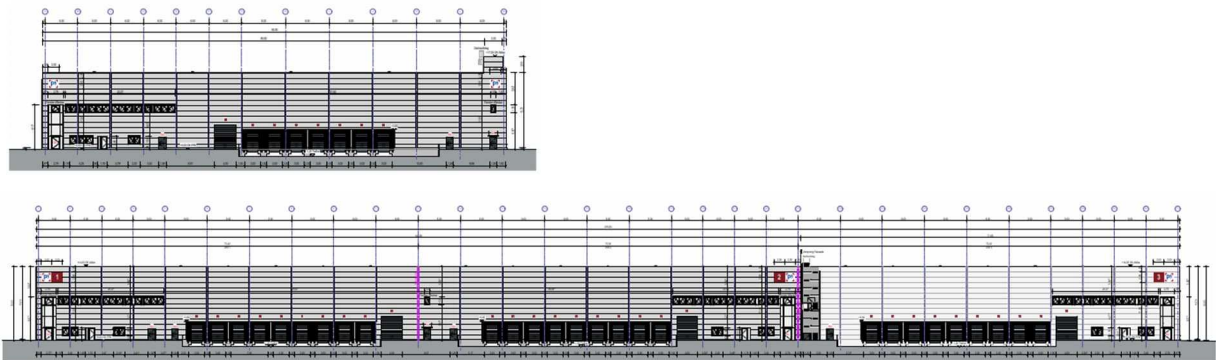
Nord-Ansicht Halle Süd (oben) und Ost-Ansicht Halle Nord (unten) /2.1.5/
